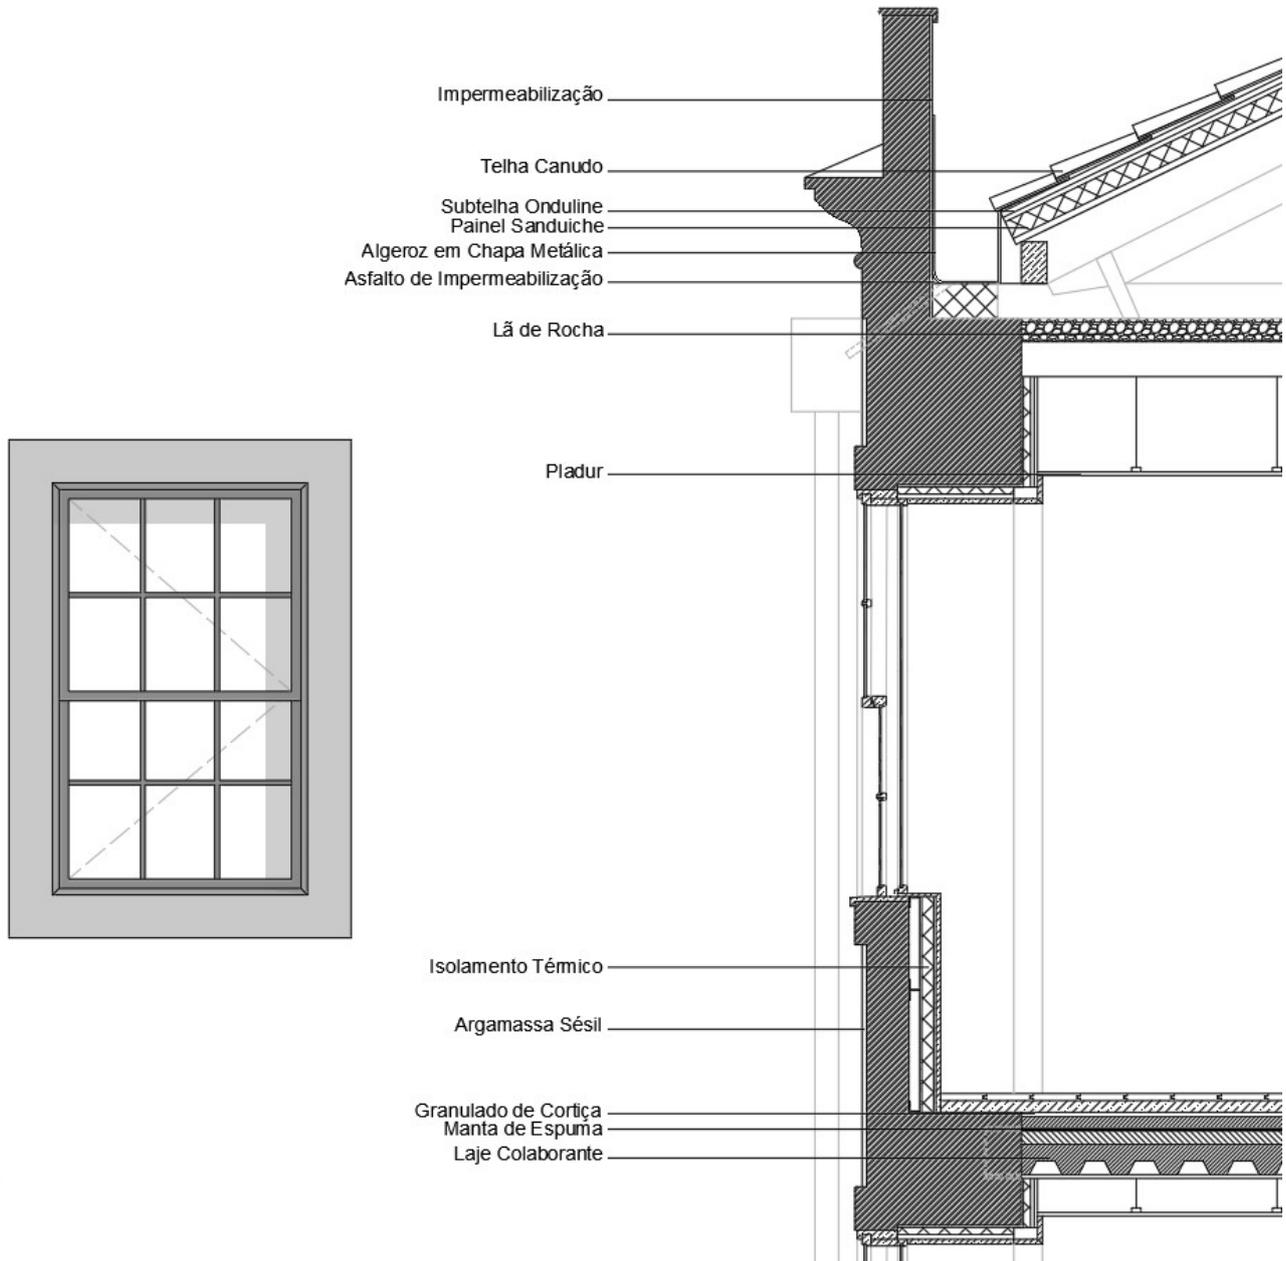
Corte Construtivo pela fachada – resolução pontes térmicas e colocação segundo caixilho (Anexo 18 e 19);
